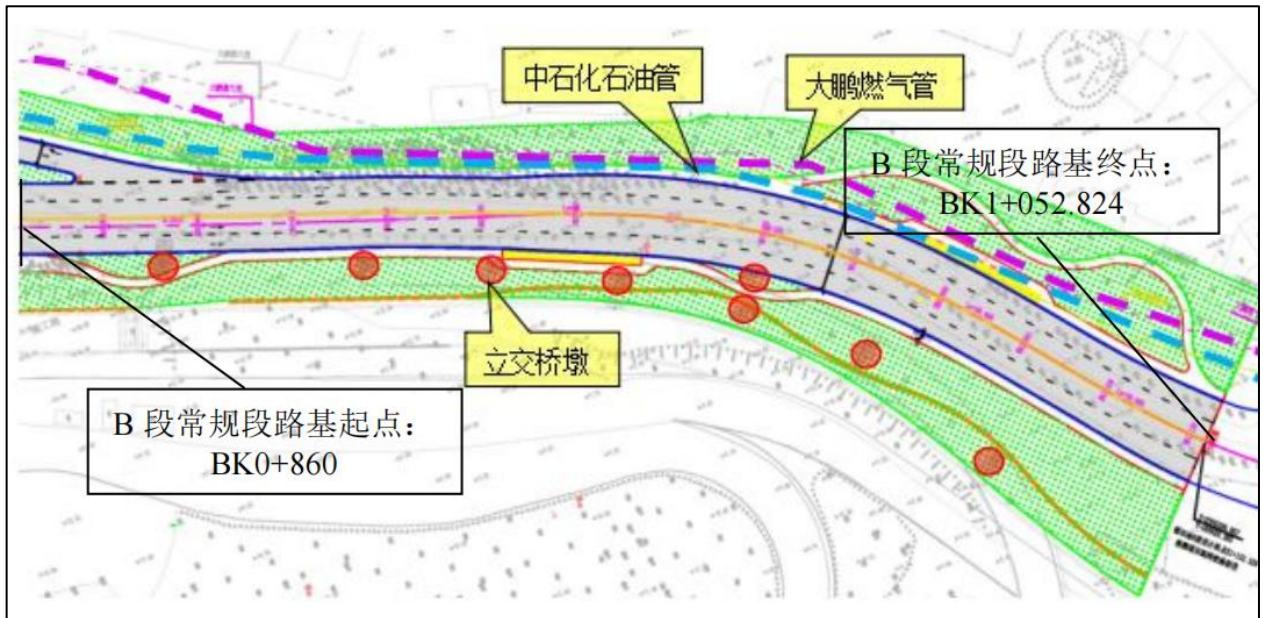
瑶田路 B 段 K0+860~终点段平面图
